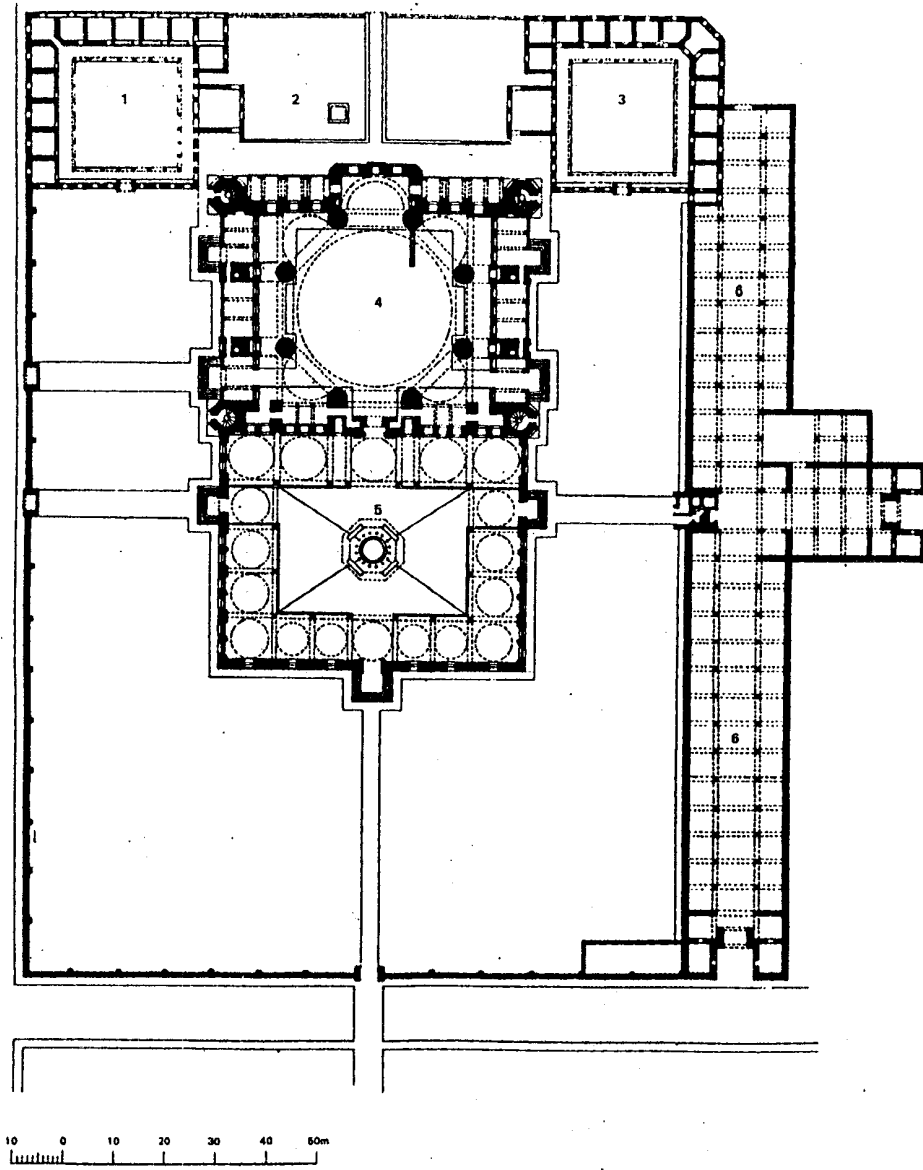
مسقط أفقي لمدرسة السلطان بايزيد (٤) ضمن مجمعه بادرته
